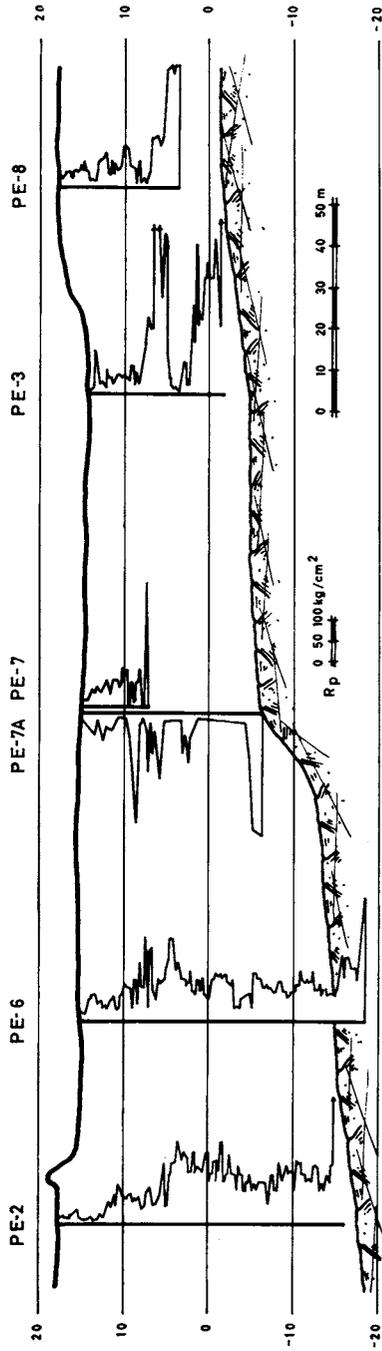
Ensaio de penetração estática na zona do vale aluvionar onde está implantado o açude
